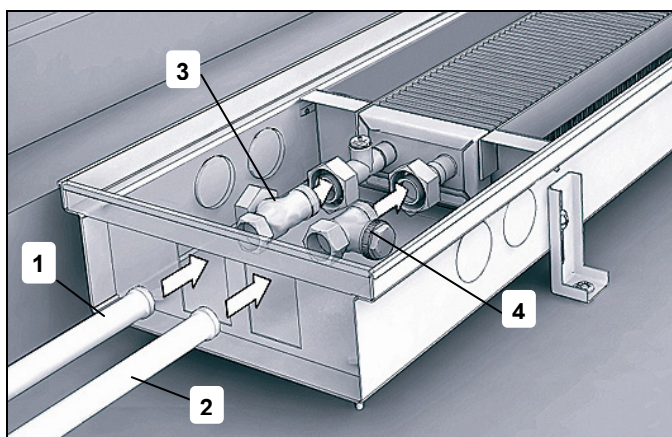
Монтаж клапанов и подвода теплопроводов:
